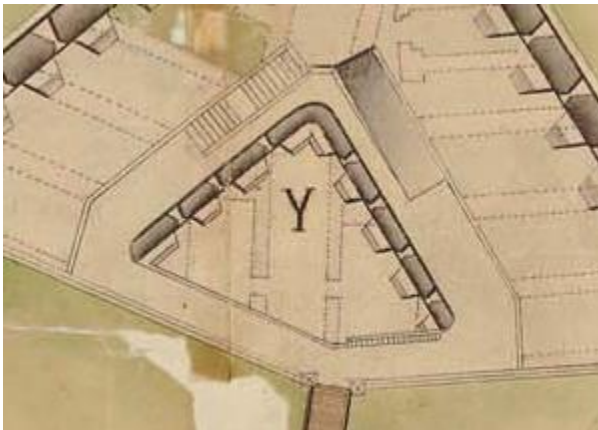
61 Planta de cubierta con la proyección de las bóvedas del interior del revellín.
